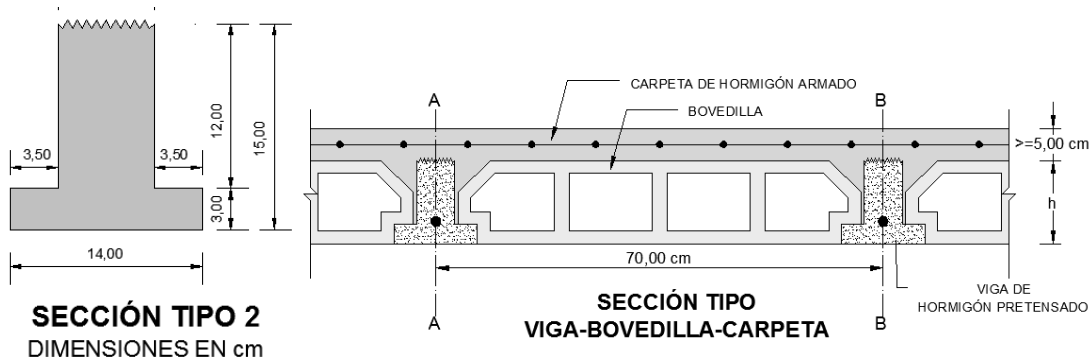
Sección Transversal inicial Viga de L=4,20 m.
